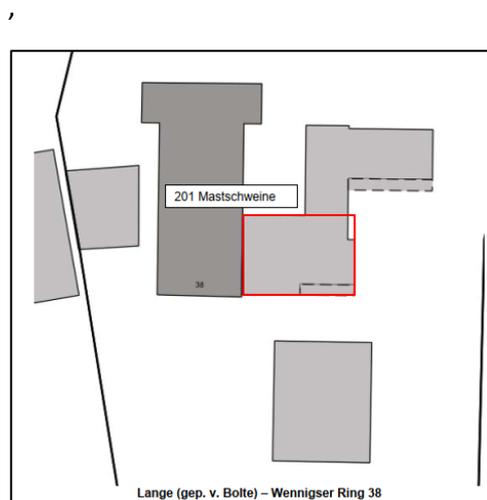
Lageplan mit genehmigten Tierzahlen Hof Lange
